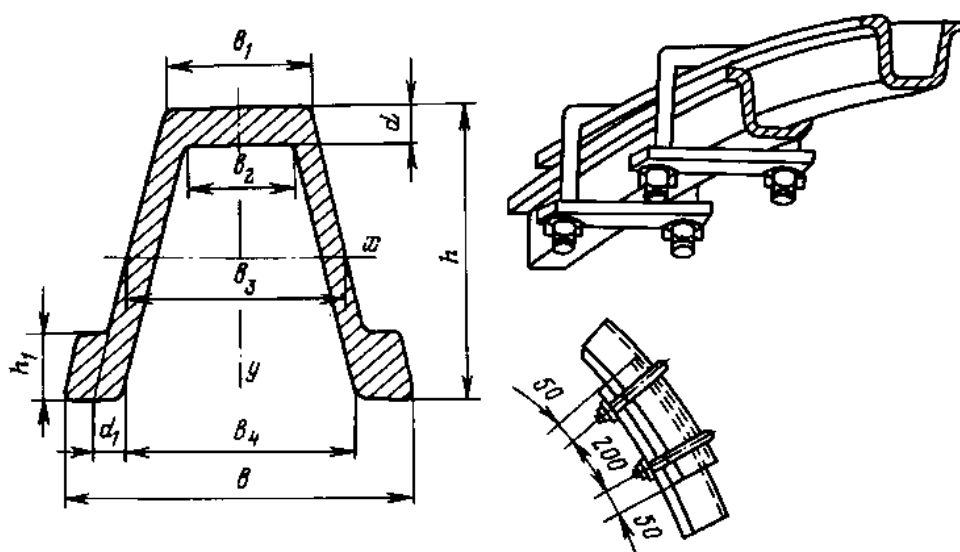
Размеры спец.профиля СВП и металлическая стяжка
